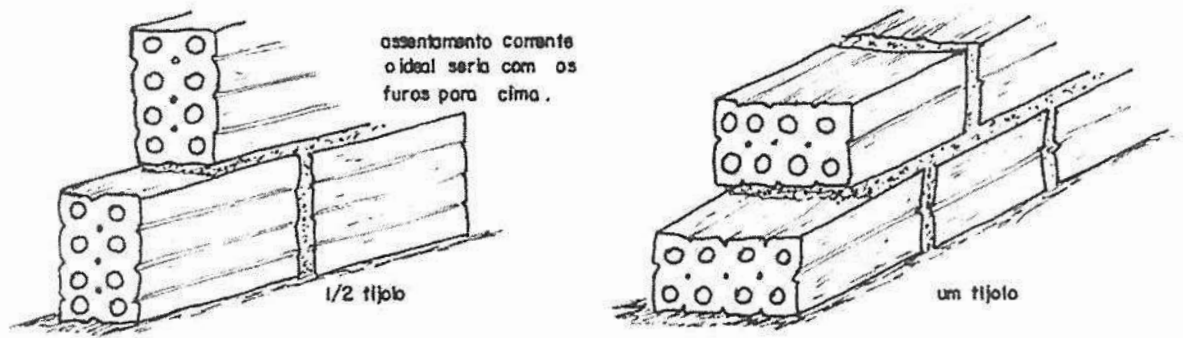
Execução de alvenaria utilizando tijolos furados.
